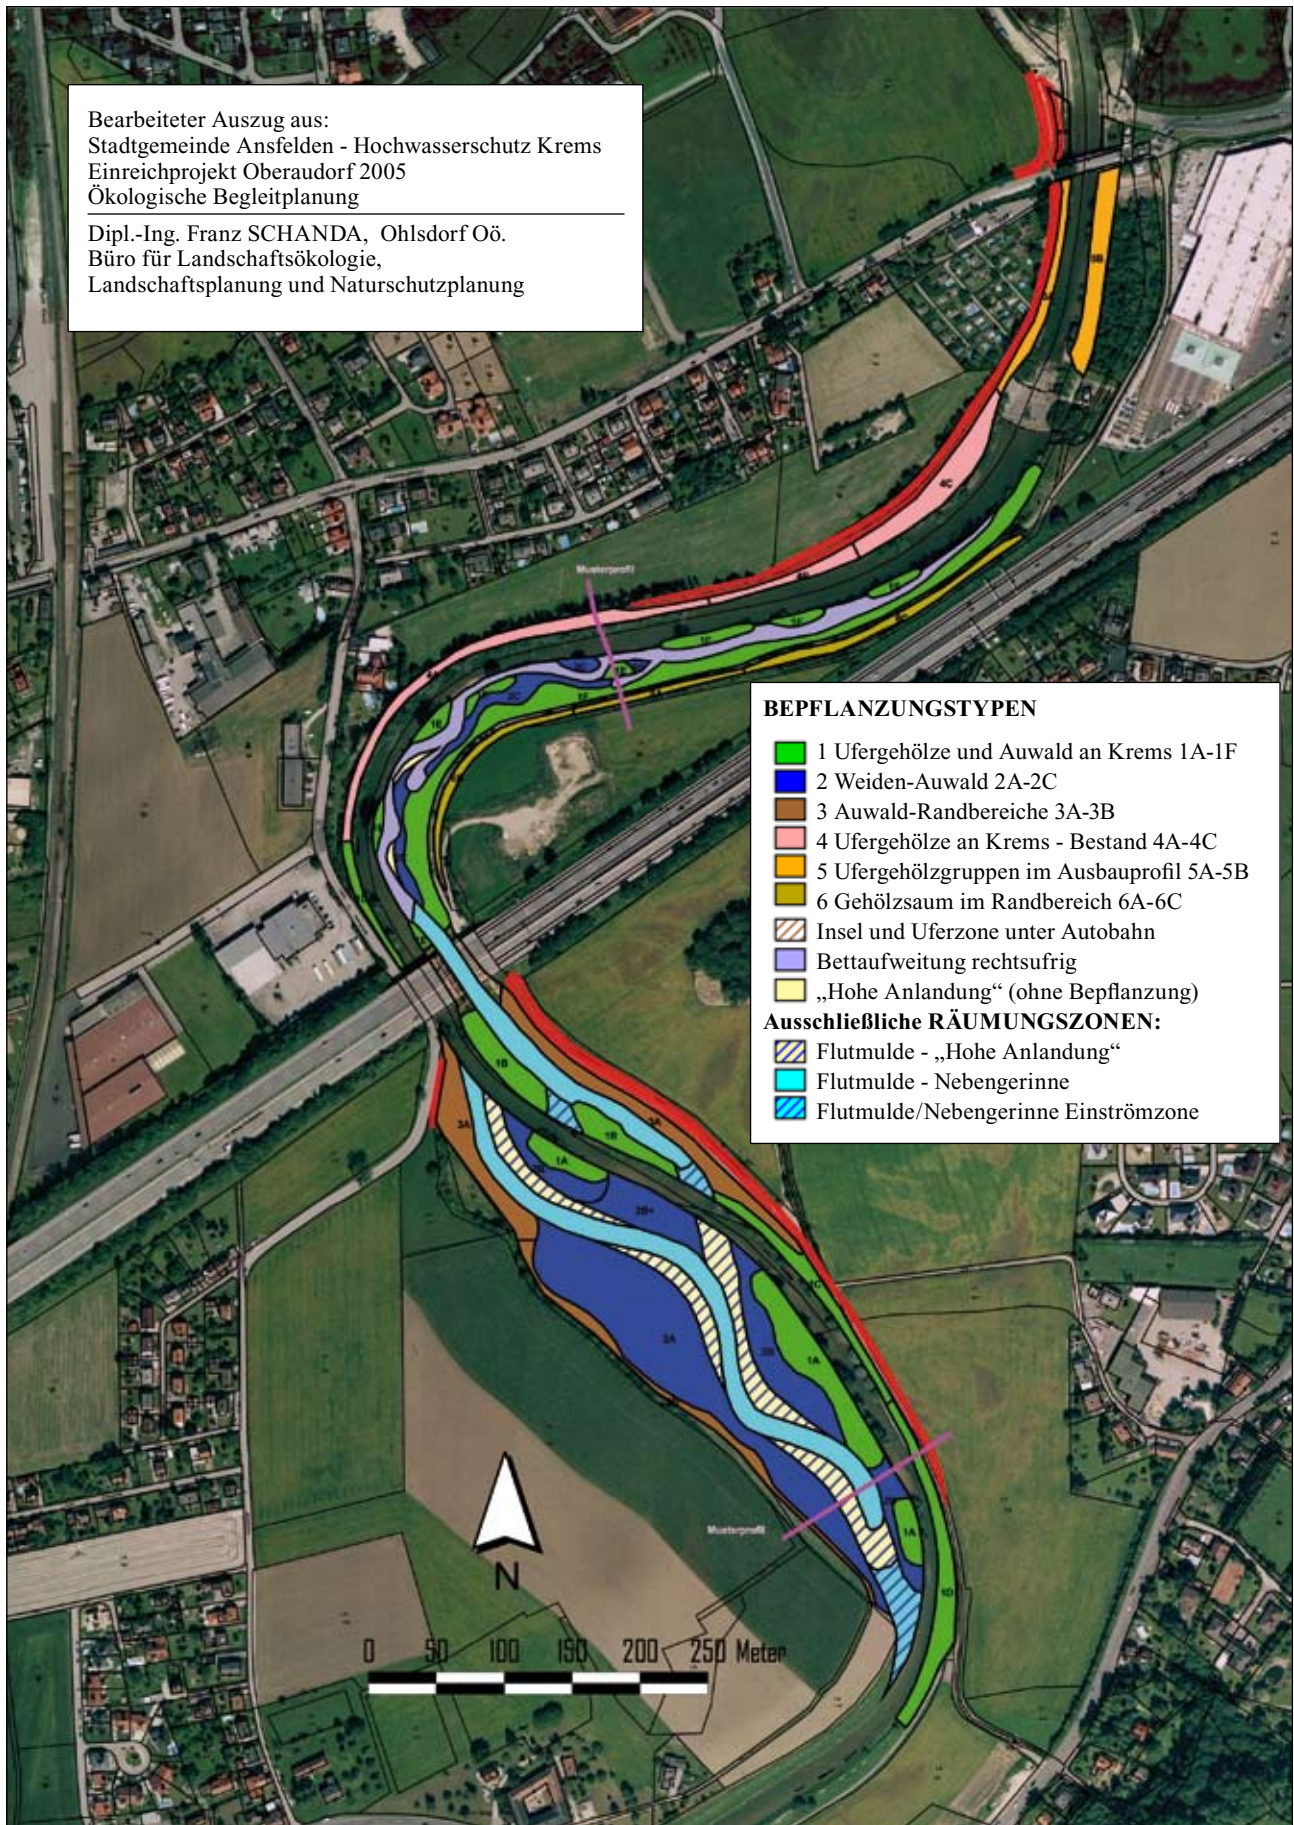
Lageplan Projekt - Maßnahmen, Vegetations-Standorttypen und Bepflanzungstypen. Maßnahmen und Einbauten im Kremslauf sind nicht dargestellt. Die randlichen roten Flächen sind Erhöhungen der bestehenden Hochwasserdämme.
